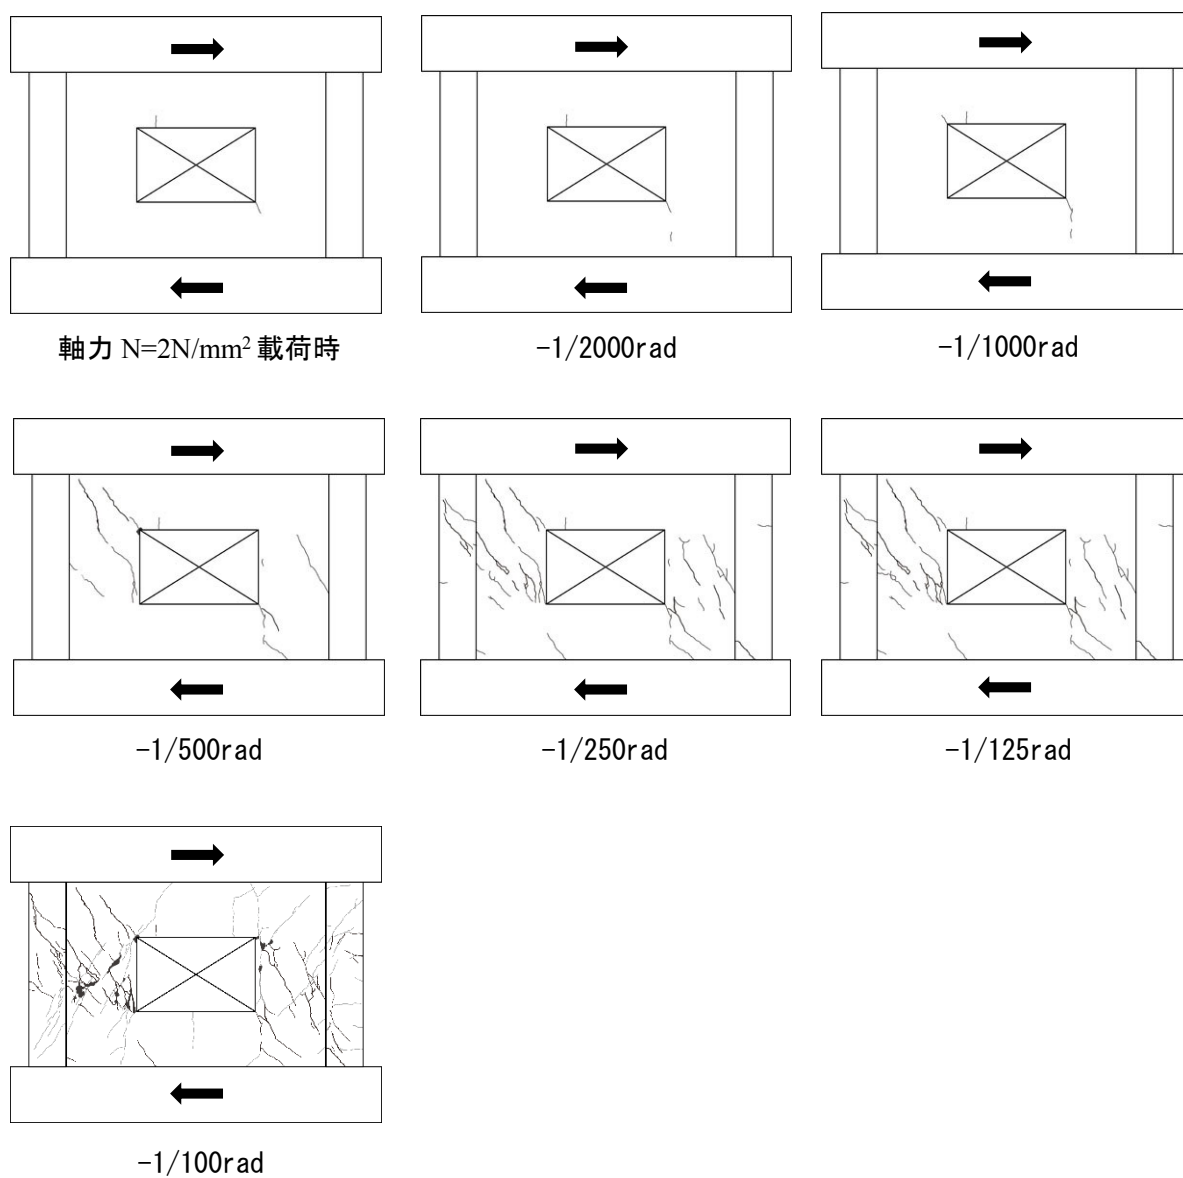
各層間変形角のひび割れ状況図 (F7-SWC-1.5) (続き)
